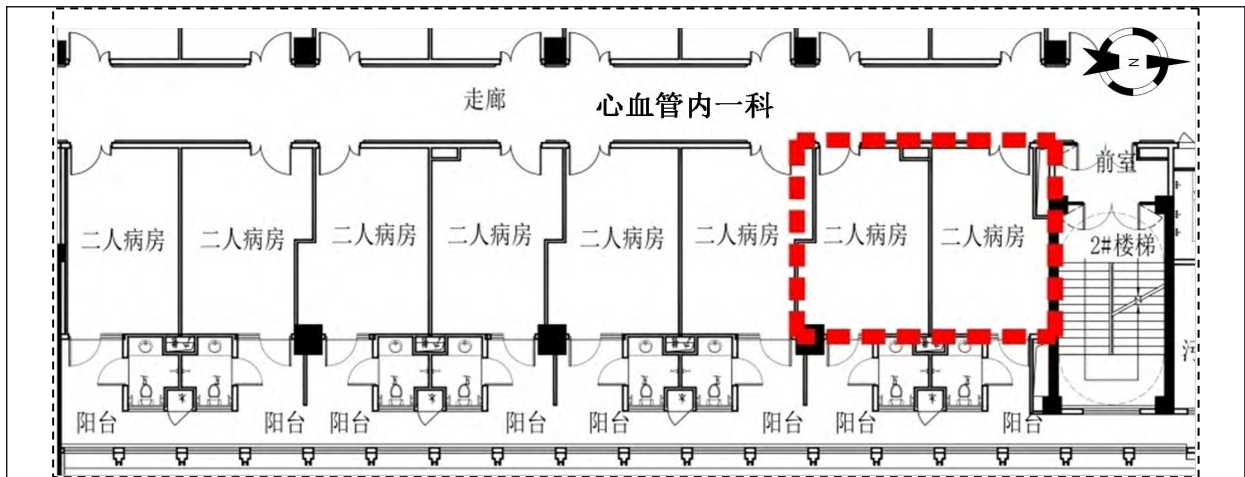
DSA 机房下方楼层平面布置图（老年医学中心楼十五楼）
